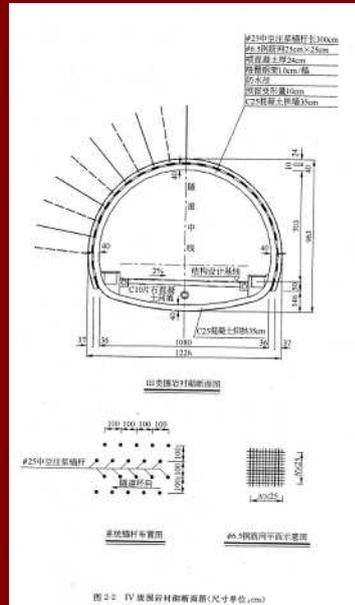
IV 级围岩衬砌断面图(尺寸单位:cm)
